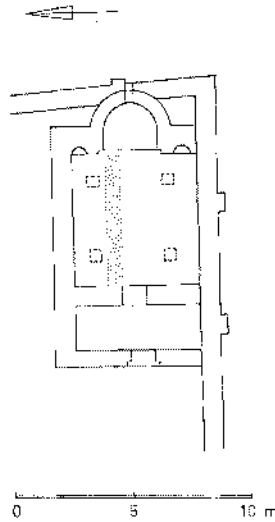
Eshab-ı Khef Hami: Grundriß, plan
